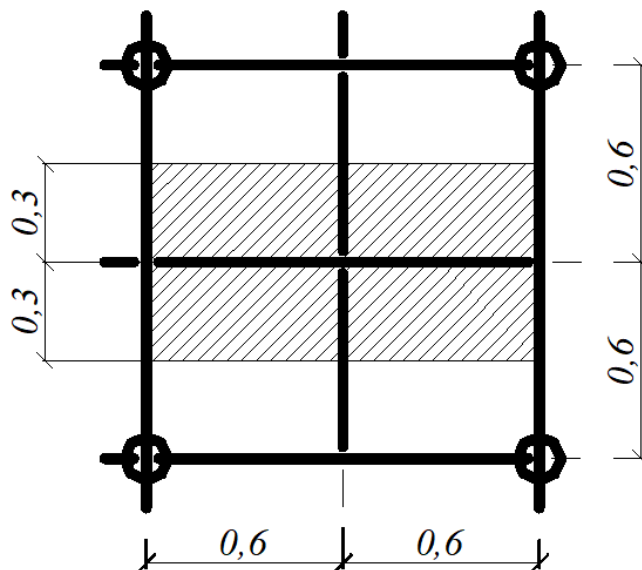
Площа навантаження на поздовжню балку.
